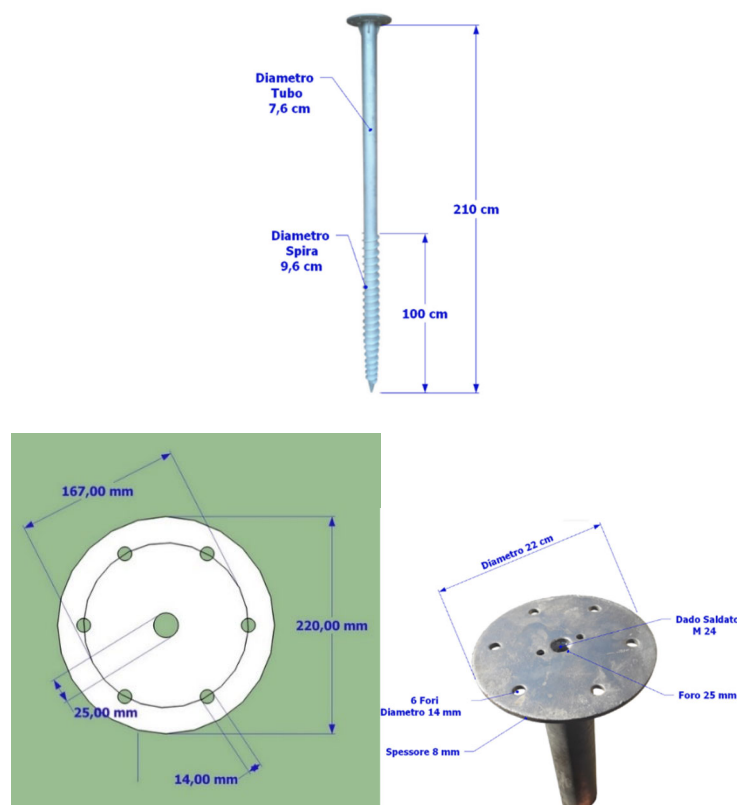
Tipologia di fondazione a vite per strutture Tracker
